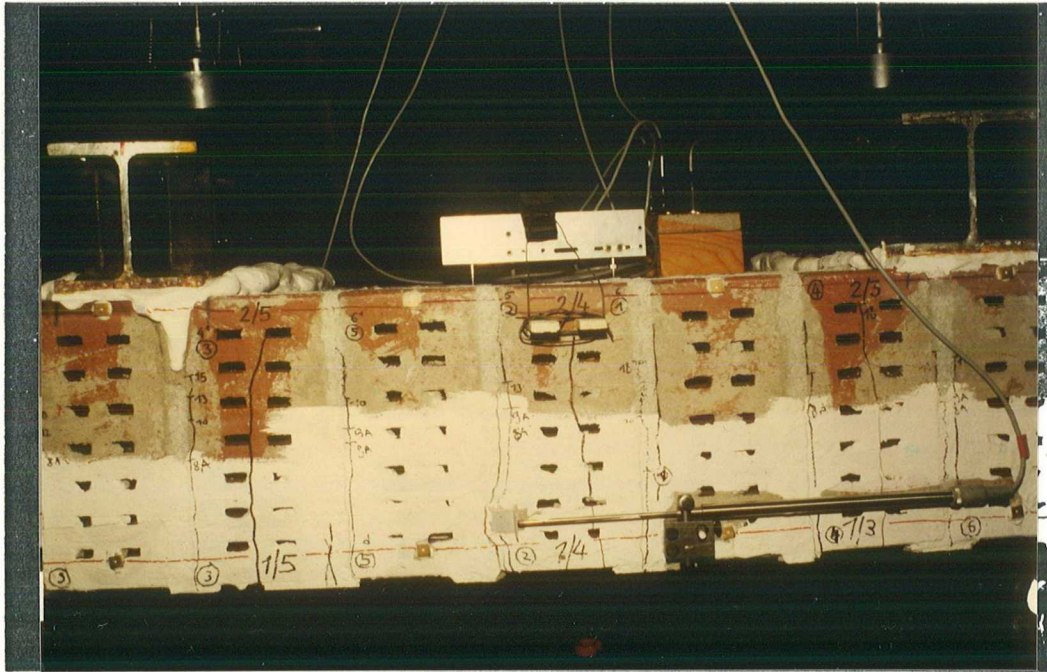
Versuch I/2a nach dem Versagen durch Biegebruch
